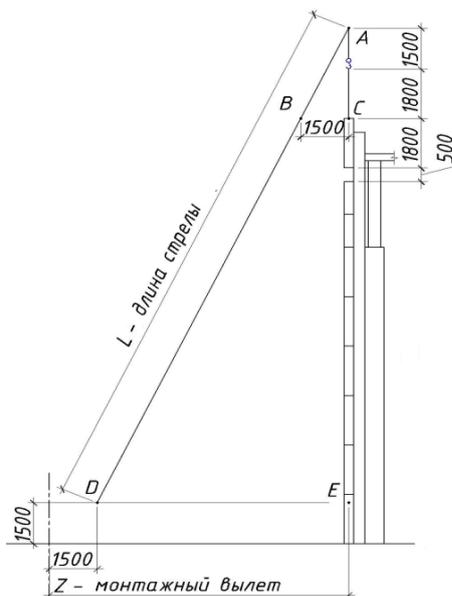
Схема к выбору крана для монтажа стеновых сэндвич-панелей
